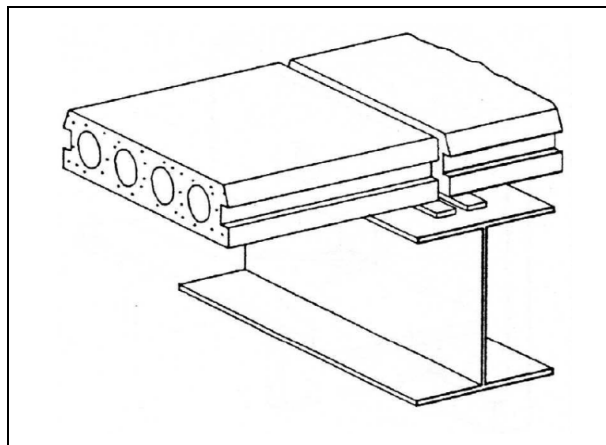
Ligação de lajes alveolares simplesmente apoiadas sobre neoprene, numa viga metálica “I”, em paralelo com a laje (PCI)
